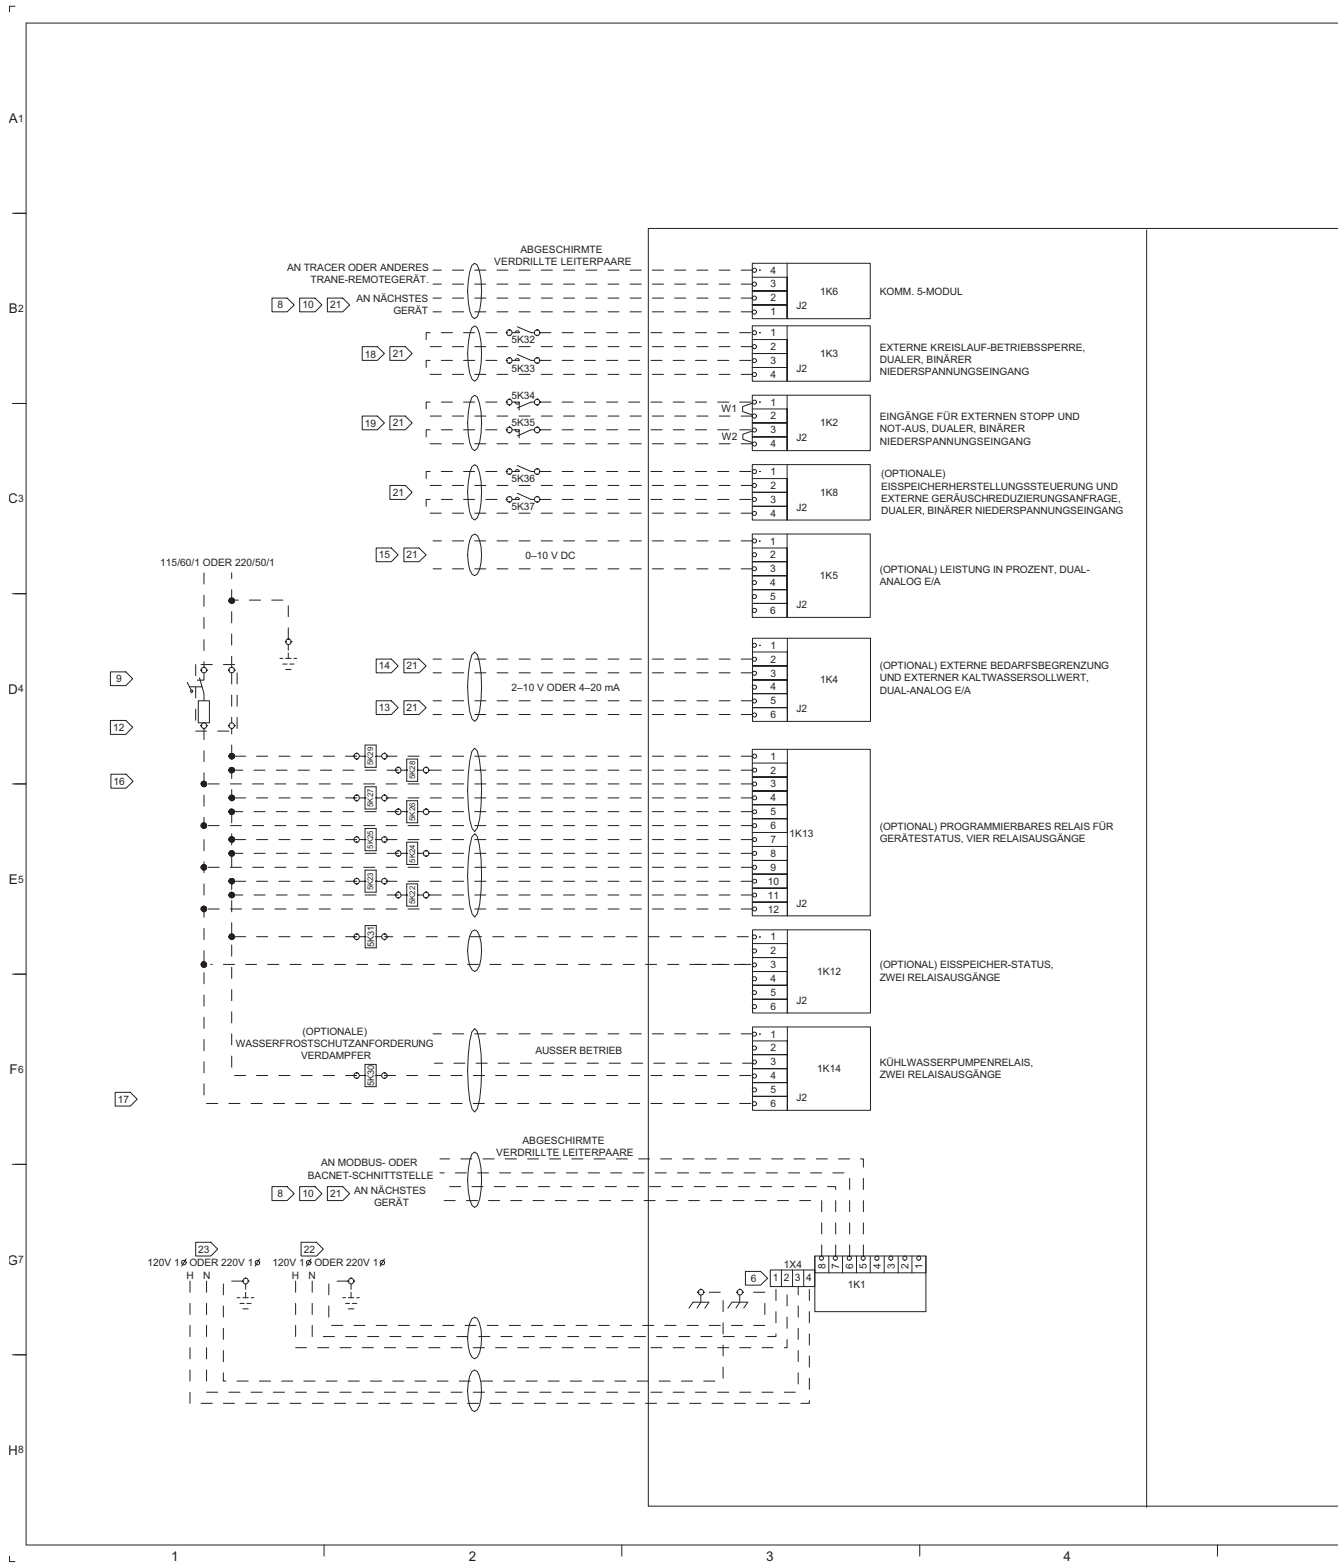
Maschinen mit einem Kreis – Stromlaufplan – Blatt 1 (Fortsetzung)
